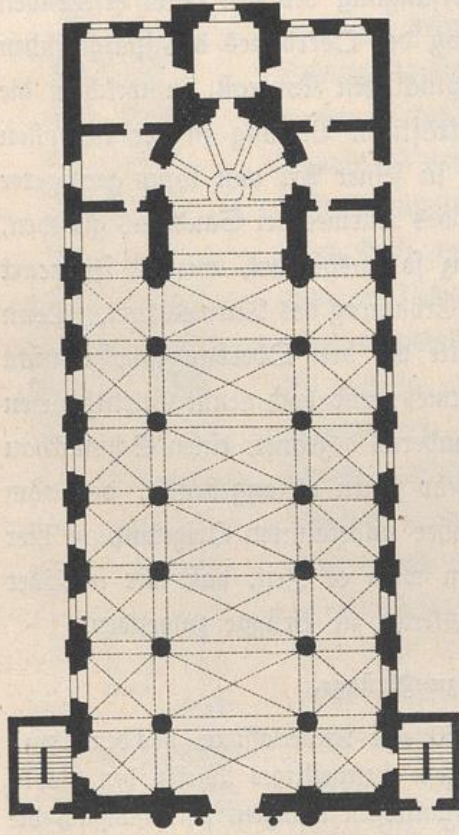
Brügge. Frühere Jesuitenkirche. Grundriß.
